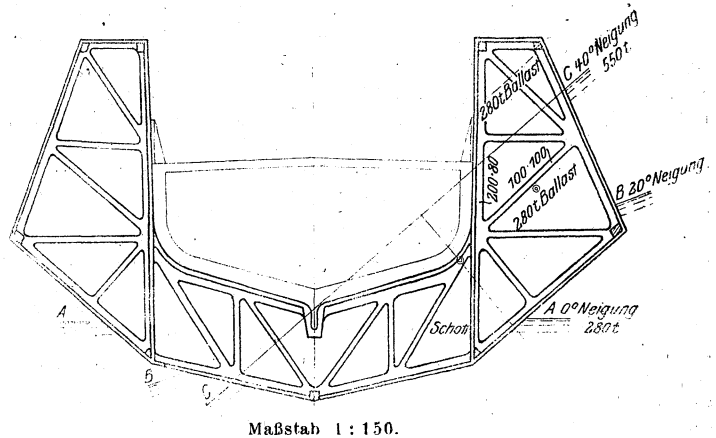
Baudock für Betonschiffe nach Wilhelm.
